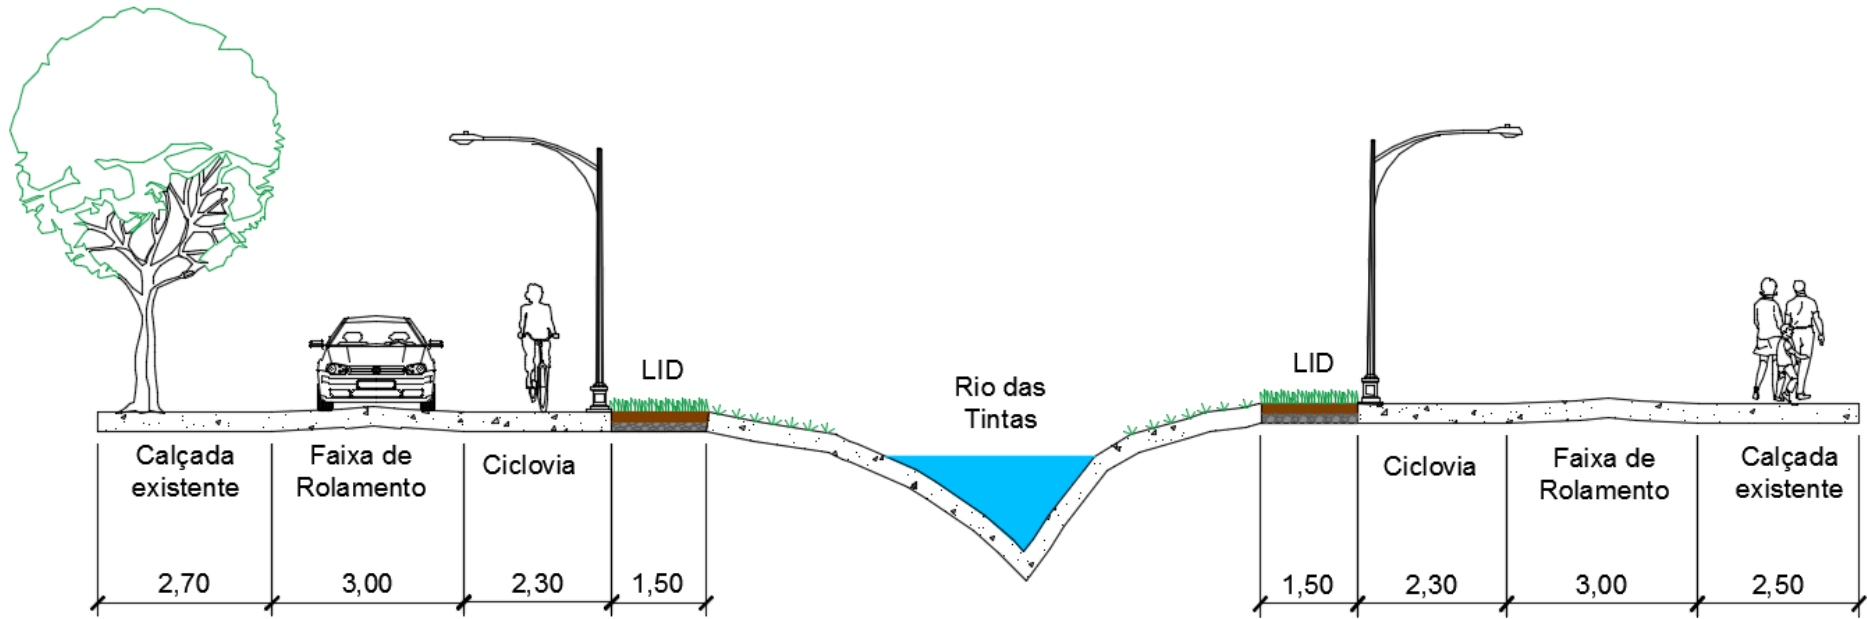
Corte longitudinal esquemático (AA) da Rua Barão de Capanema
